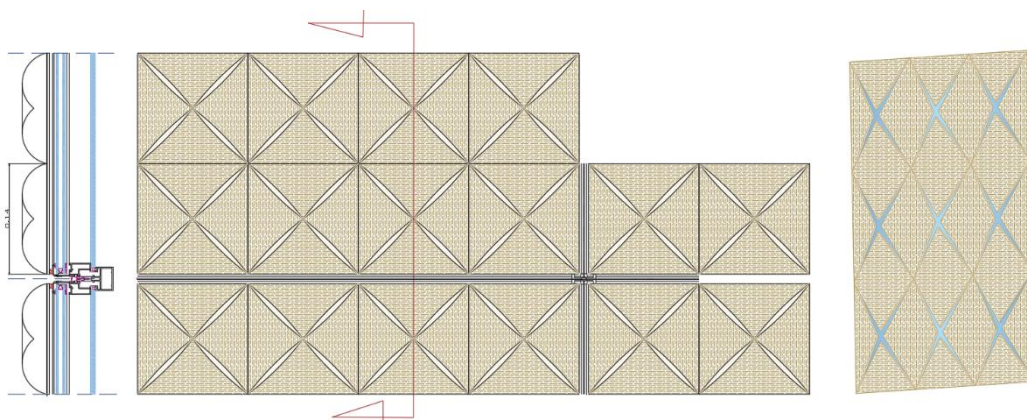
détail de fixation des hygromorphes sur la façade (source : auteurs).
